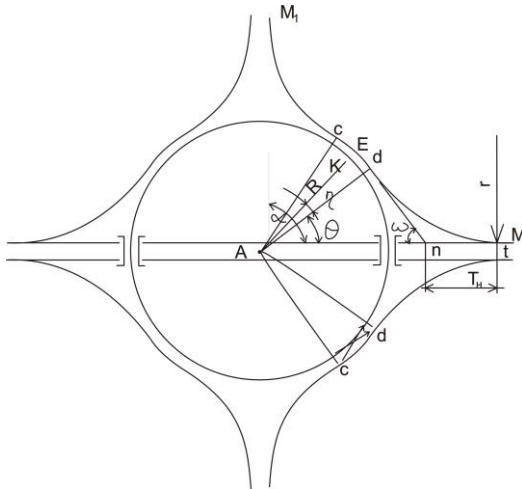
Схема до розрахунку елементів перехрещення за типом кола з двома шляхопроводами
